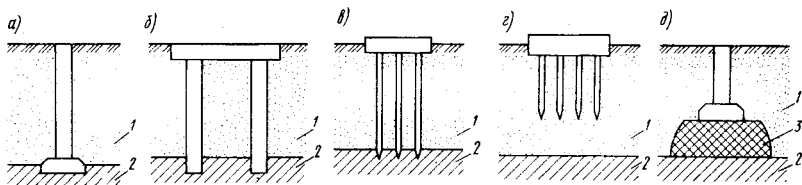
Назначение глубины заложения фундаментов при напластованиях грунтов по типу 2:
